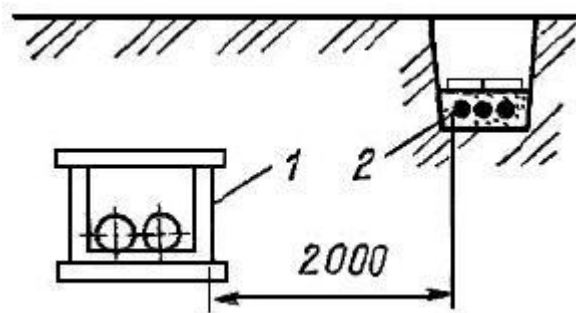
Прокладка кабелей рядом с фундаментом здания и сооружений
